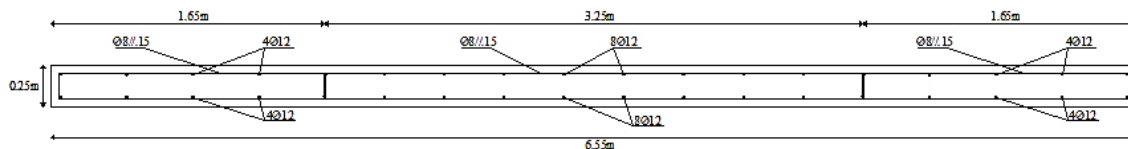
Figura G - Secção transversal das paredes resistentes de betão armado adicionadas na direção transversal.
